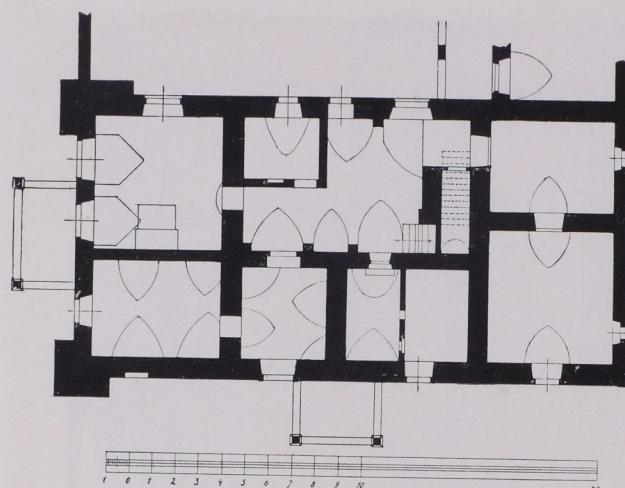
Hallein, Schloß Kalsperg, Grundriß im Erdgeschoß 1:300 (S. 162).
